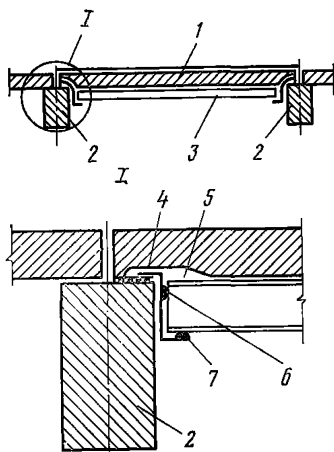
Усиление перекрытия при прогибе только у наружной стены
